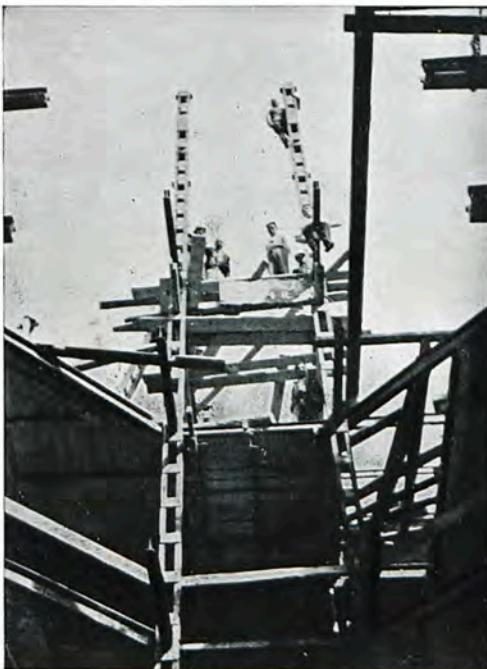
Vue de l'ossature métallique, montrant les poutres obliques horizontales des galeries entourant la cage de l'escalier.
